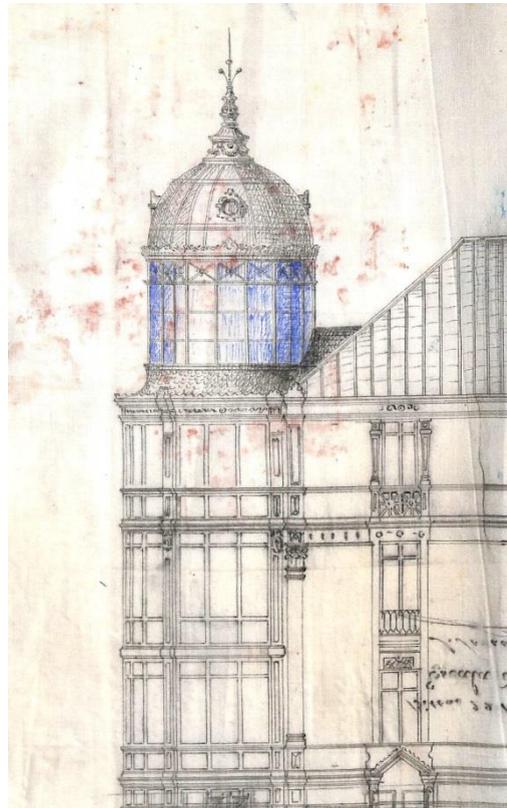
Detalle del alzado de un torreón para la casa de Félix Murga y Félix Arana. Julio Saracíbar. 1885. Bilbao
